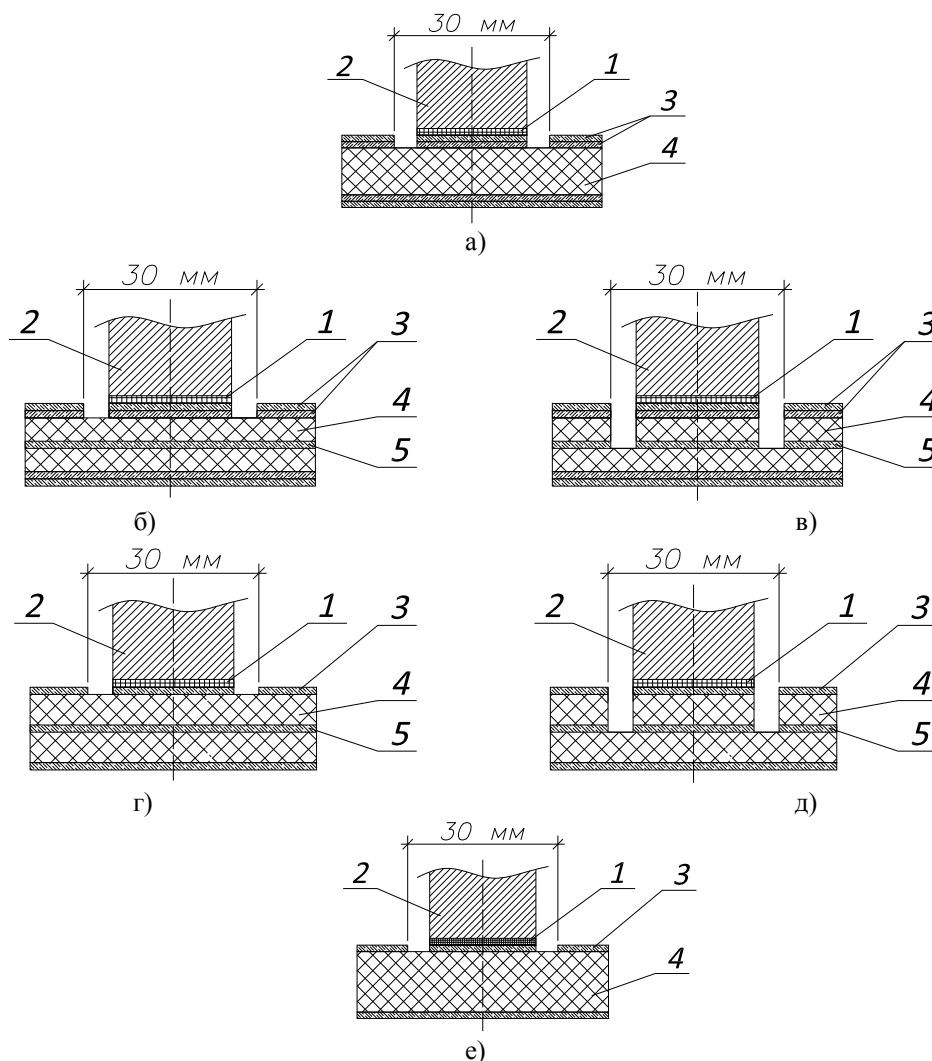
Схемы установки цилиндров при испытании: а) схема сборки № 1 (наружные листы шпона); б) схема сборки № 2 (наружные листы шпона); в) схема сборки № 2 (центральный лист шпона); г) схема сборки № 3 (наружные листы шпона); д) схема сборки № 3 (центральный лист шпона); е) схема сборки № 4 (наружные листы шпона). 1 – слой эпоксидного клея; 2 – берёзовый цилиндр; 3 – наружные листы шпона; 4 – центральный лист шпона
